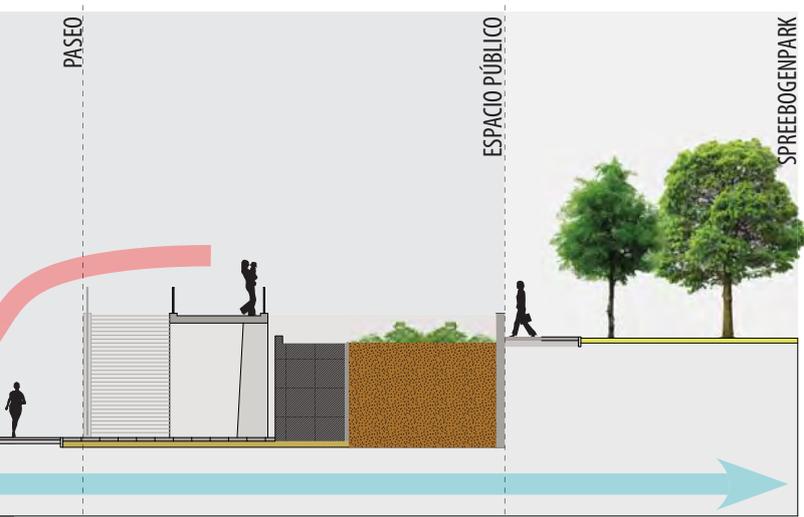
Sección tipo proxima a Willy-Brandt strasse
